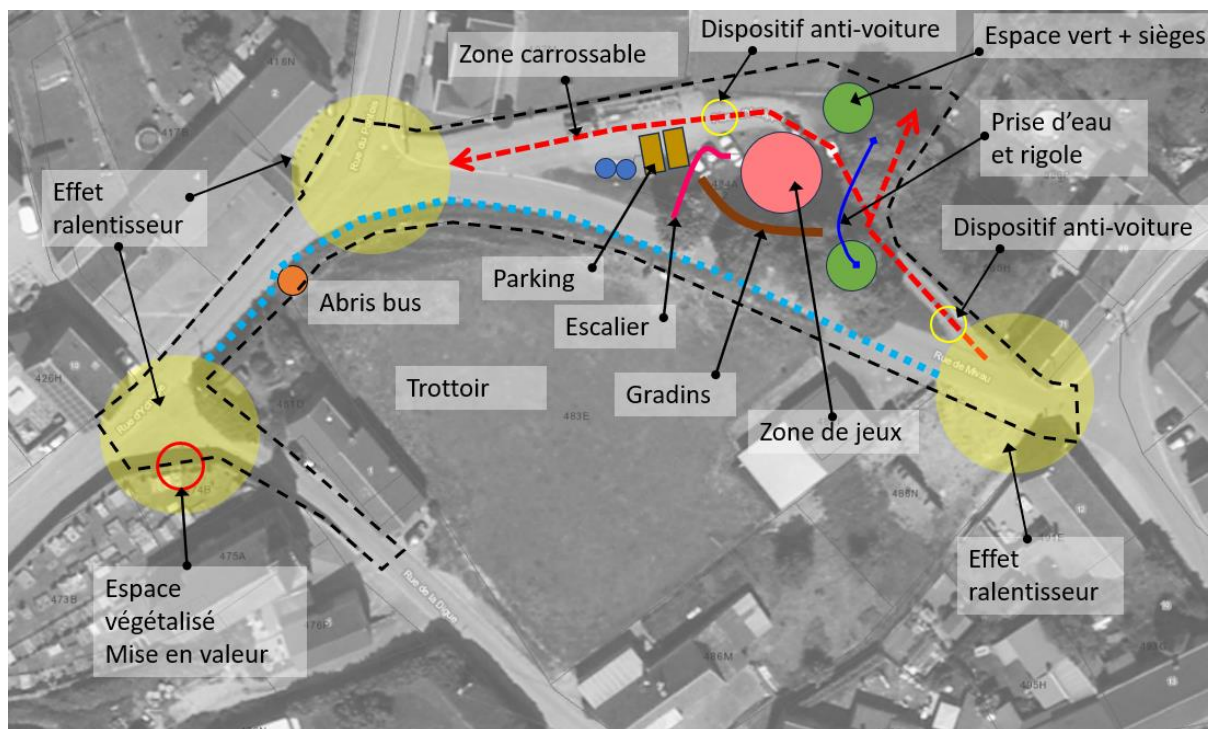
Schéma des aménagements proposés (Fond de plan : orthophoto 2022 – Carto : DR(EA)²M, 2023)
